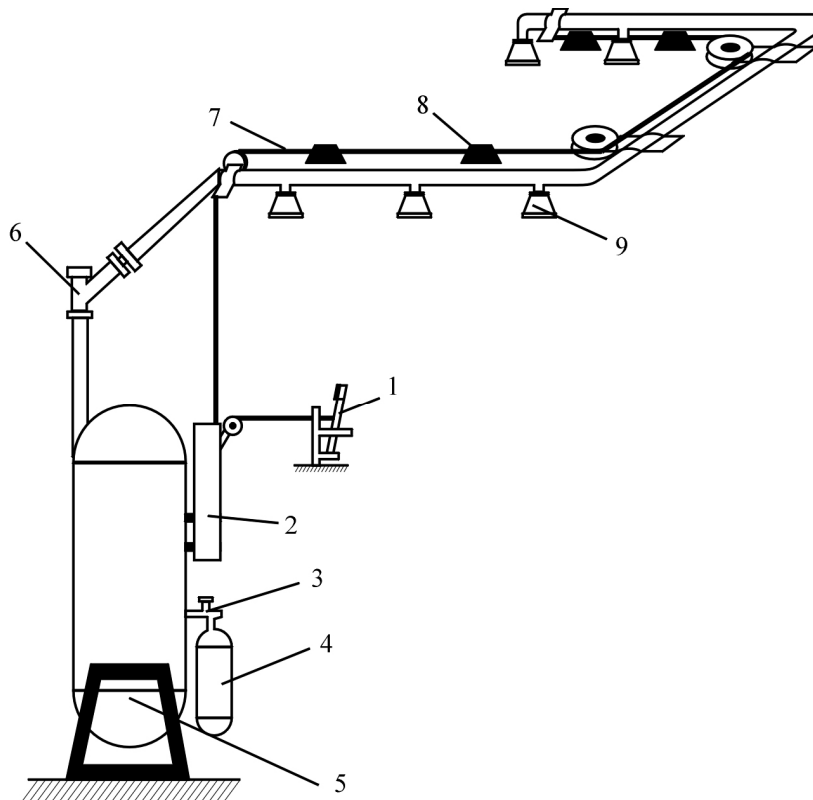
Принципова схема автоматичного порошкового вогнегасника типу ОПА: 1 – рукоятка ручного пуску; 2 – напрямна труба з вантажем; 3 – запірно-пусковий пристрій; 4 – балон зі стиснутим газом; 5 – корпус вогнегасника; 6 – клапан пневматичний; 7 – трос; 8 – легкоплавкий замок; 9 – насадок
